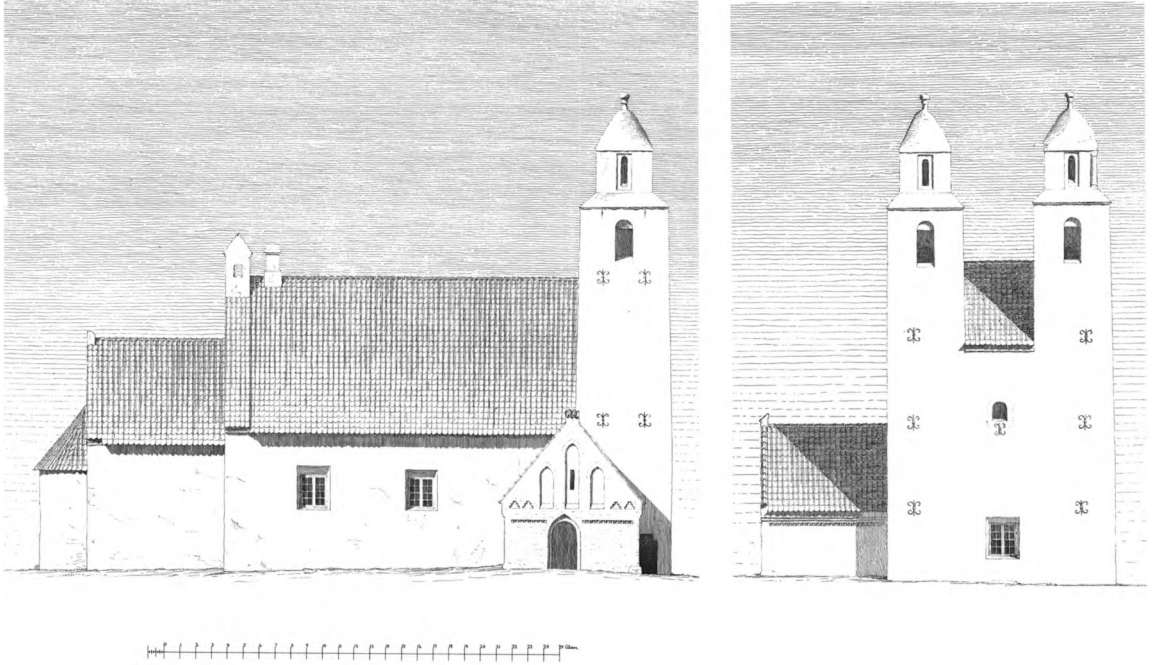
b. Opstalter. 1:300. a. Nordfacade. b. Vestfacade. Målt og tegnet af H. B. Storck 1888. - *Elevations. a. North facade, b. West facade.
